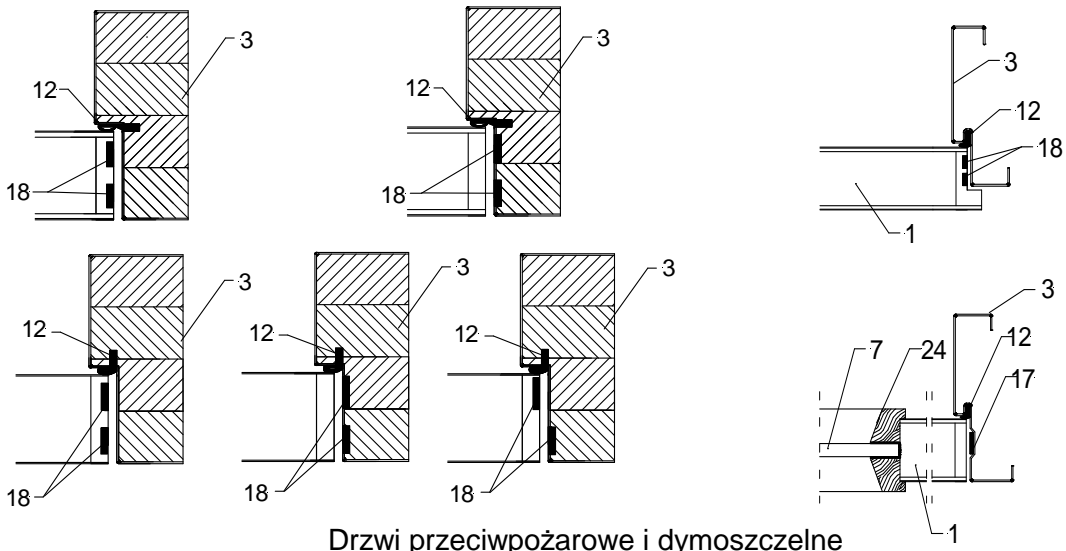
Drzwi typu HALSPAN EI 60 - przekroje poziome B - B
